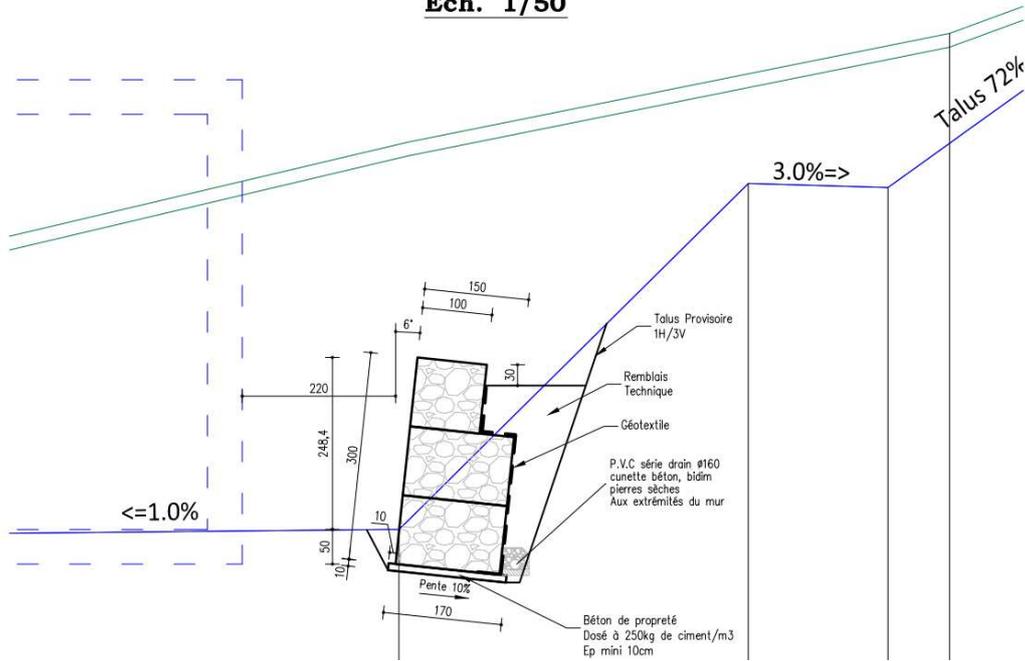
coupe de l'ouvrage de soutènement en gabions
